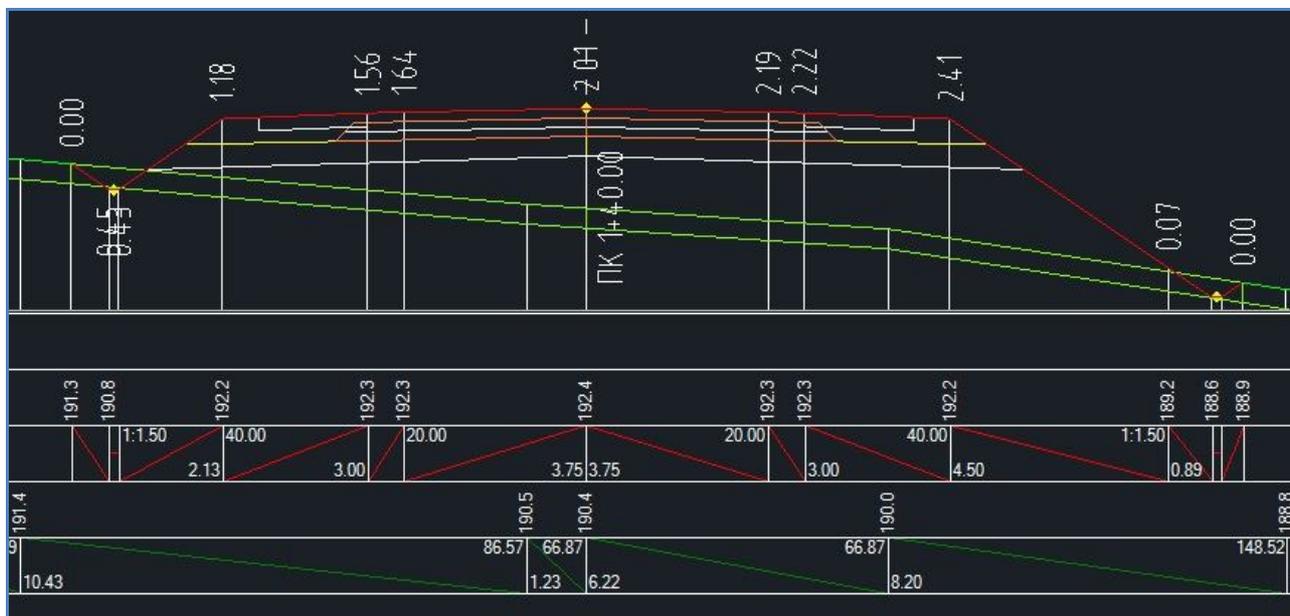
Вид поперечного профиля с укрепленными обочинами
